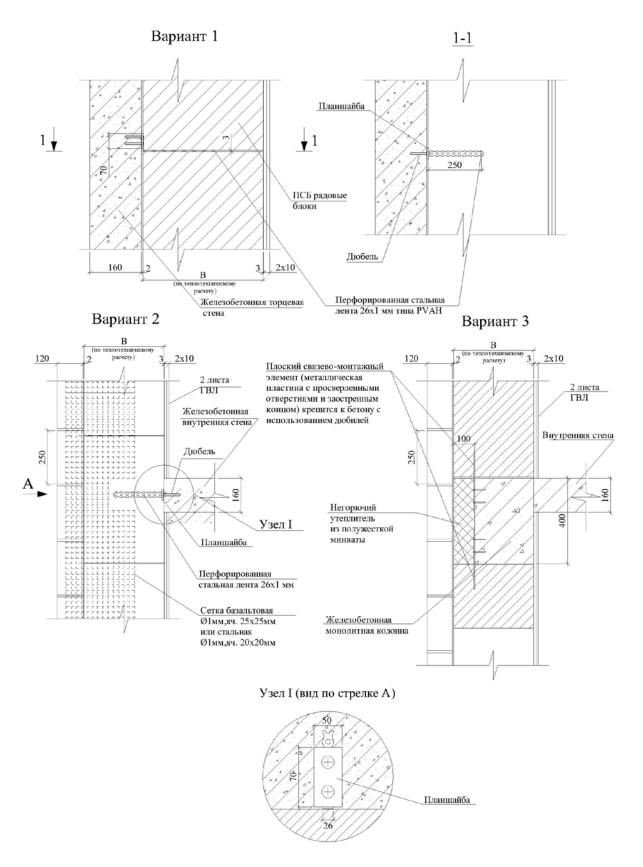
Крепление кладки из ПСБ блоков к несущим железобетонным стенам и колоннам
